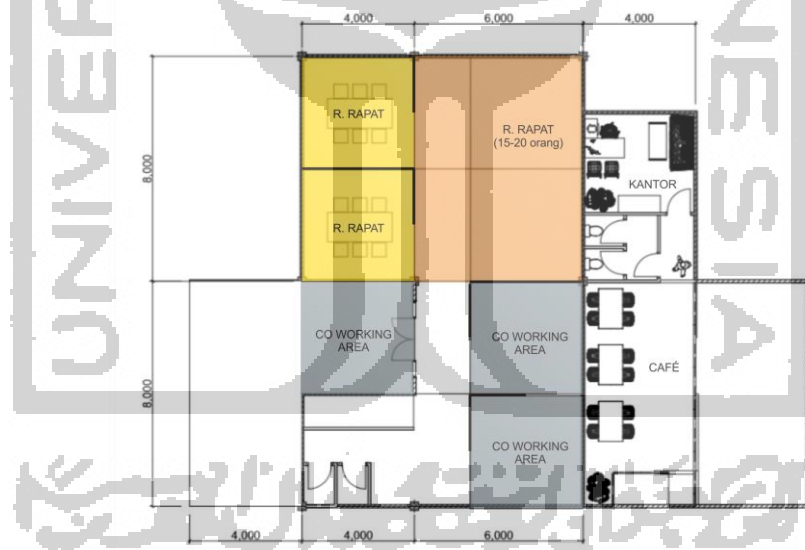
20 alternatif zonasi area r. rapat, co working dan classroom fleksibel
